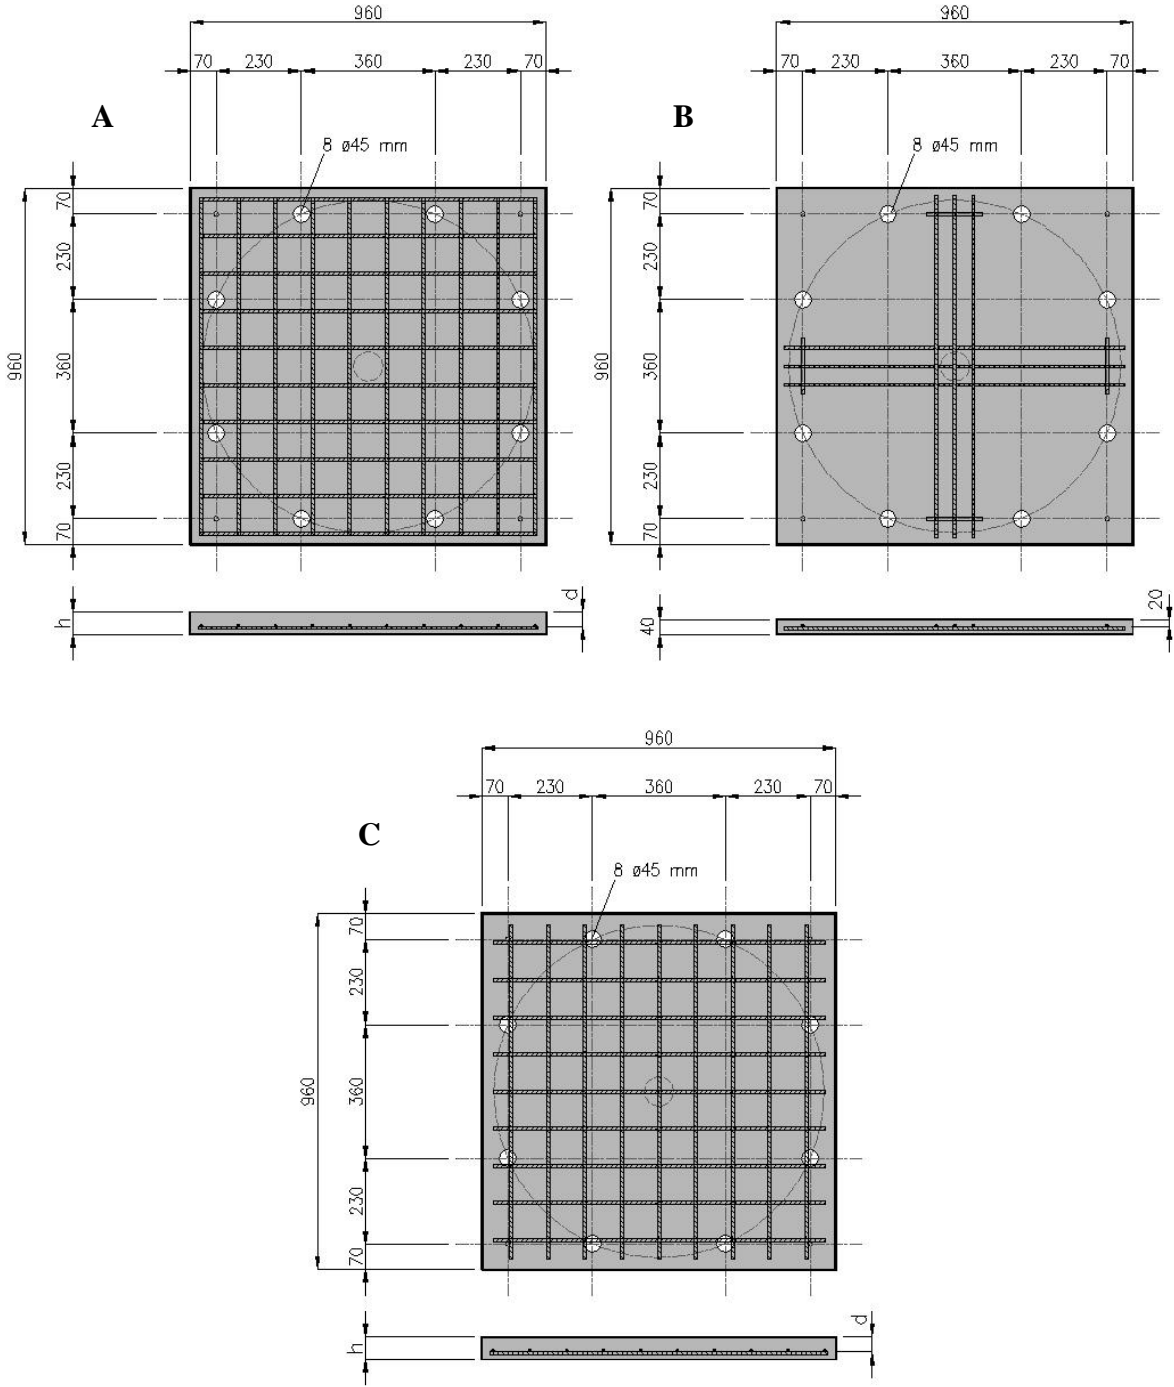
Géométrie des dalles et arrangement des armatures
